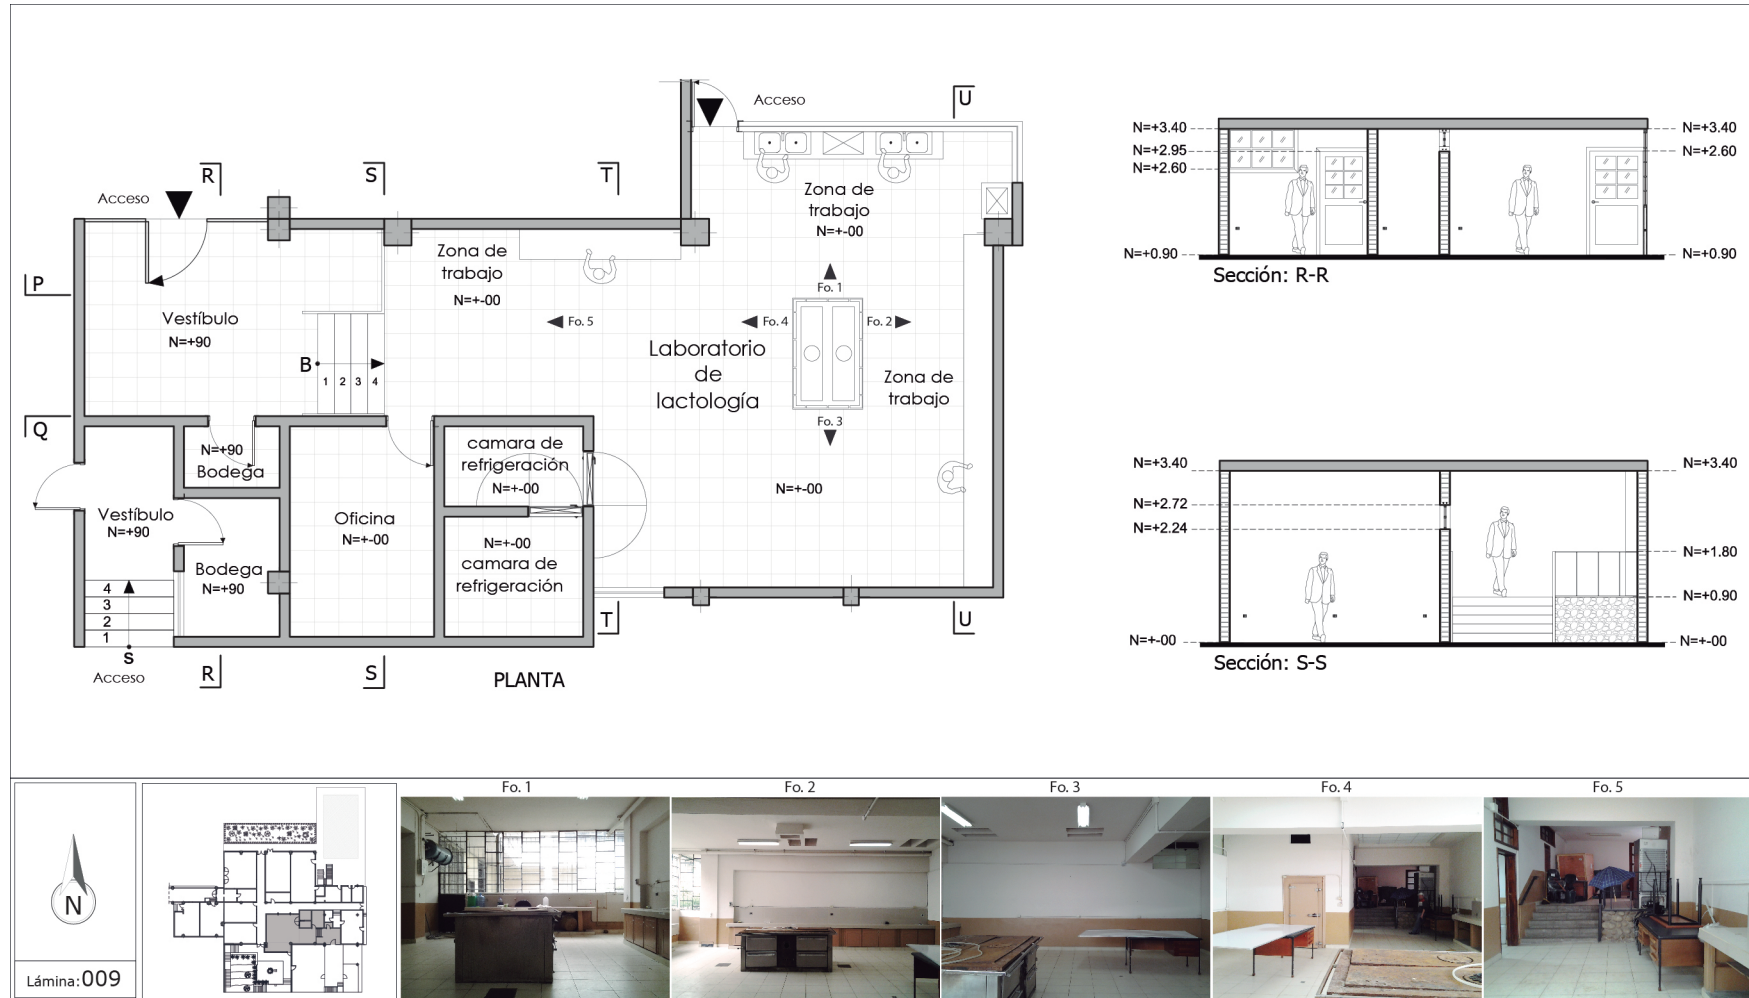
Planta y secciones del laboratorio de lactología estado actual.
